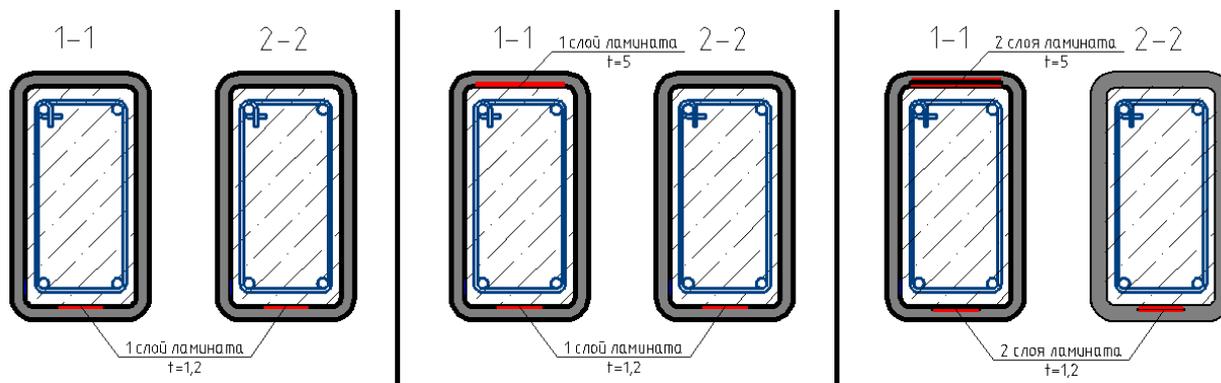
Варианты поперечного сечения балок, усиленных одиночной и двойной арматурой в растянутой и сжатой зонах (Авторская разработка)
